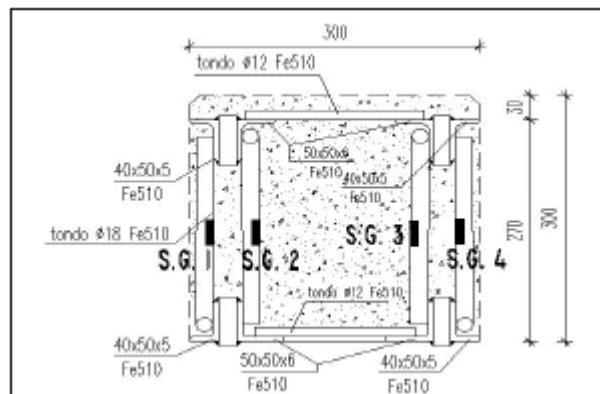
Posizionamento strain-gauges trave in seconda fase: sezione tipo
